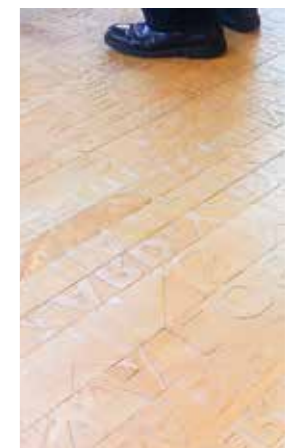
Pavimento da Sala de Crianças (Piso 1).
